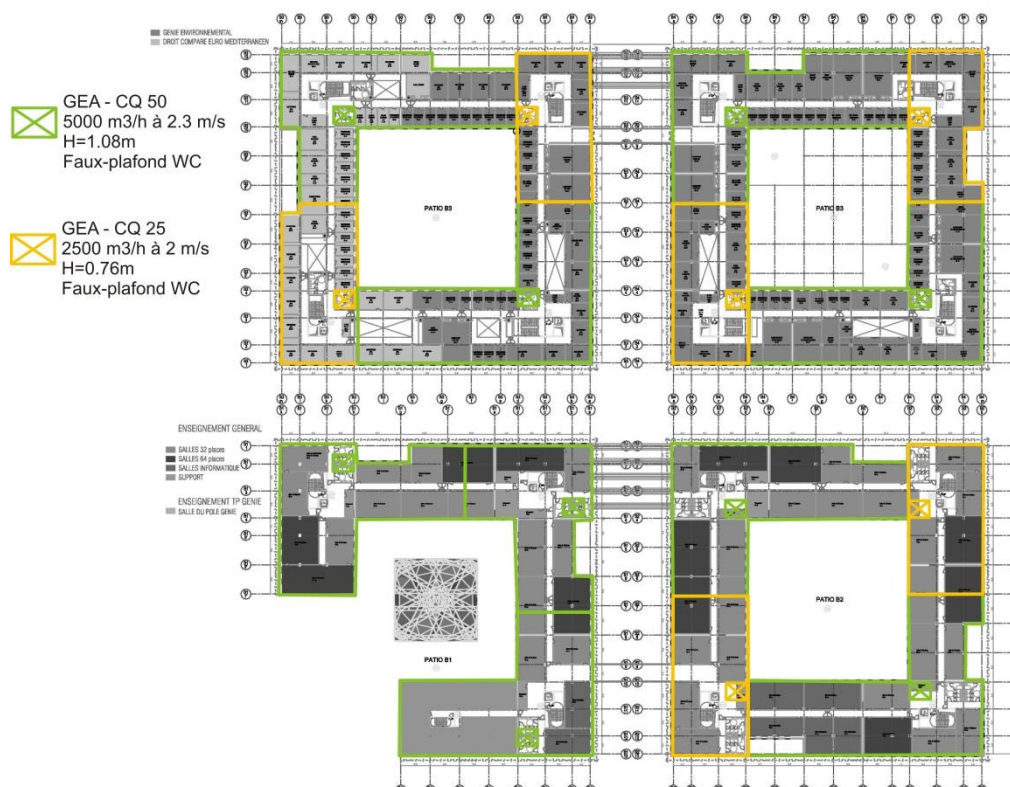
Plan d'implantation des CTA – B1B2 R2 – B3B4 R1
